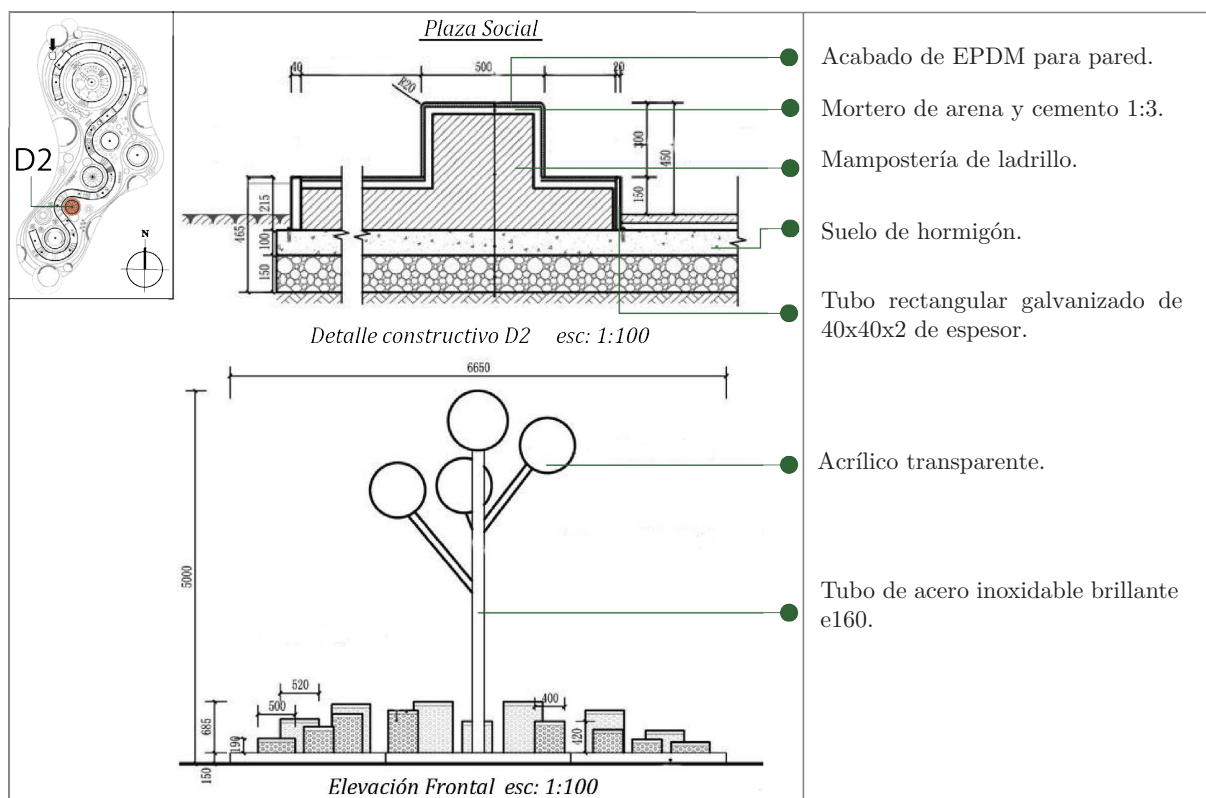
Técnicas constructivas. Fuente: 100architects (2021). Elaboración: Propia.
